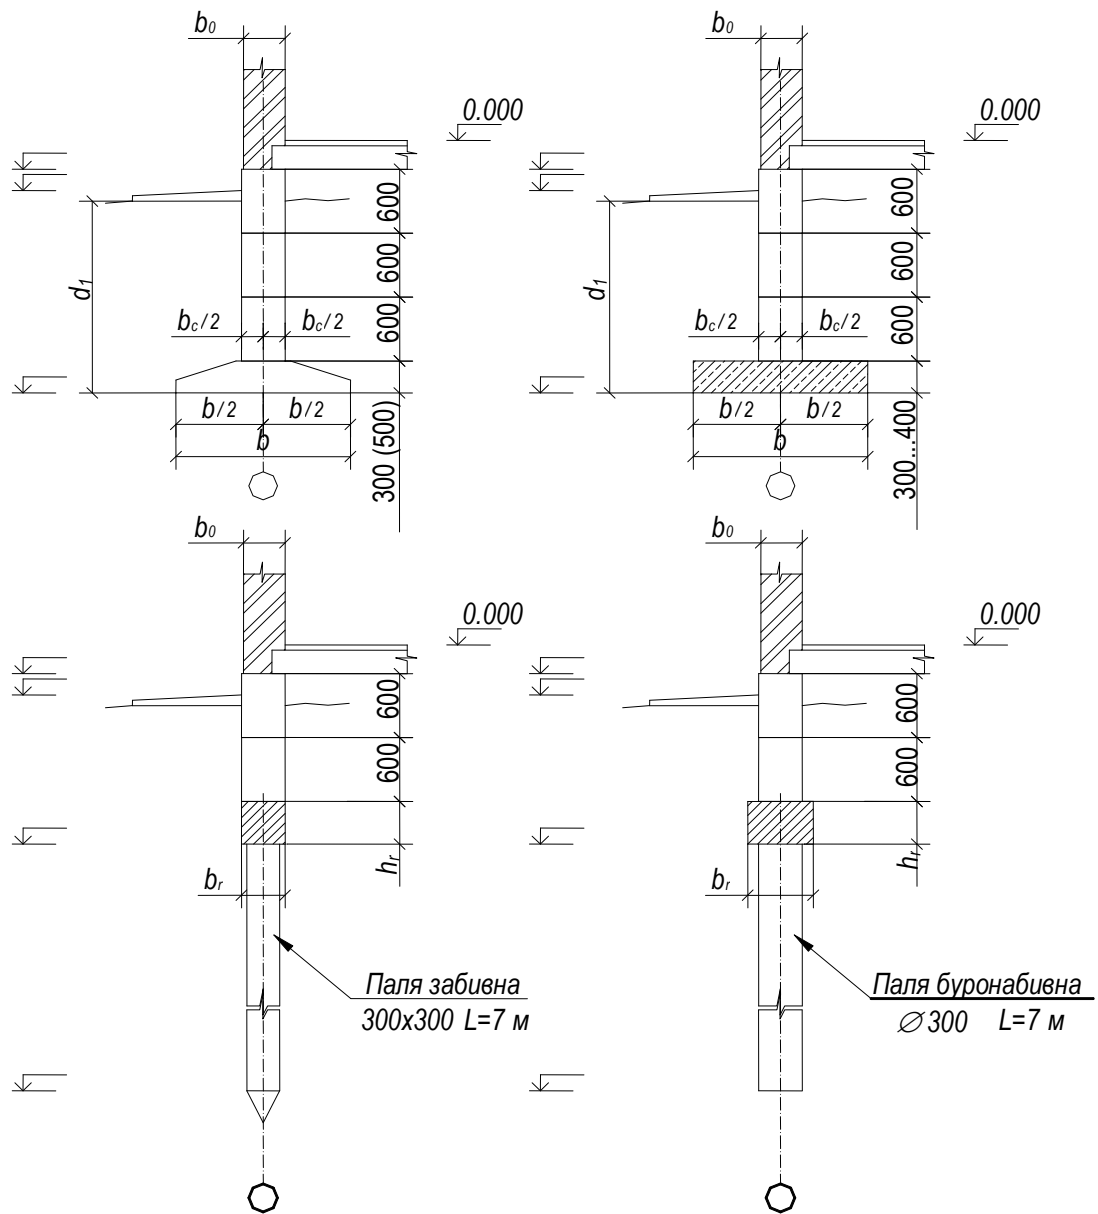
Перерізи варіантів стрічкових фундаментів, що розглядаються як конкурентноздатні: а – стрічковий із збірних залізобетонних плит і бетонних стінових блоків; б – стрічковий із монолітної залізобетонної плити та бетонних стінових блоків; в – пильовий із забивних палей; г – пильовий із буронабивних палей
